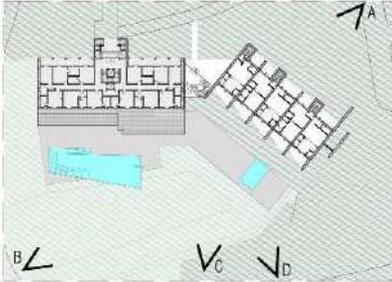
Progetto prospetti e sezioni – Stralcio Tav. PA06
